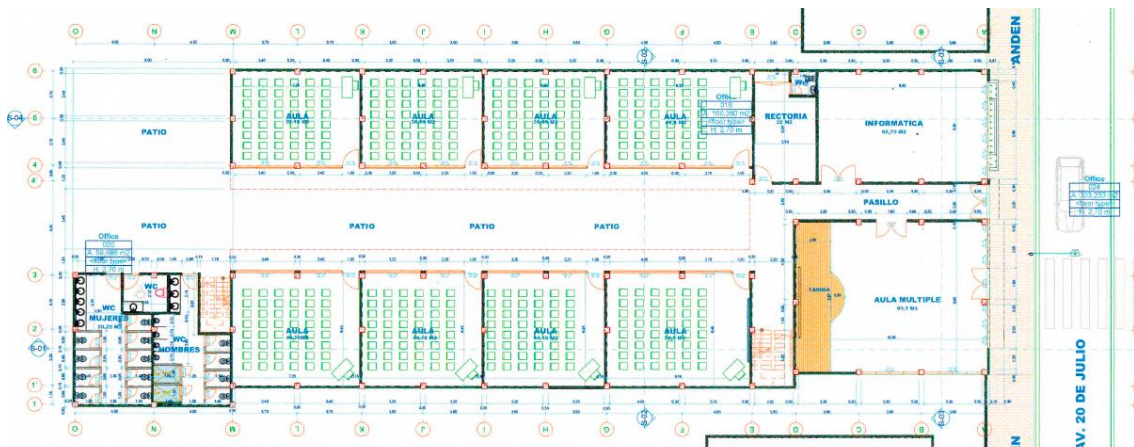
Planta 1er Piso Aula Múltiple y Auditorio.
